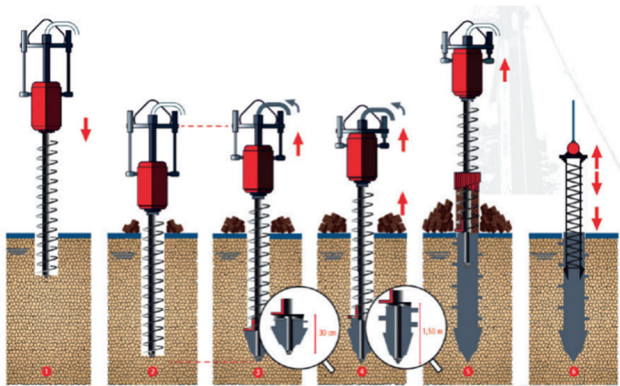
Fases de ejecución de pilas de cimentación T-PILE®.
